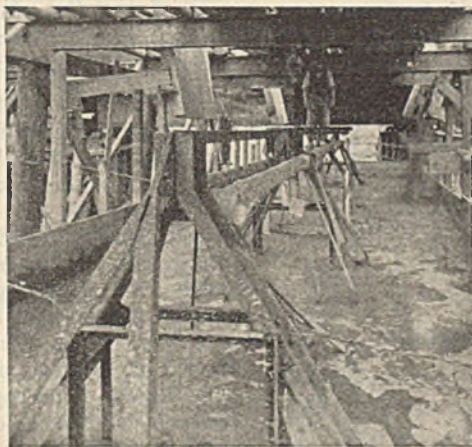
Unter der Plattform des Schüttgerüsts für Pfeiler II.
